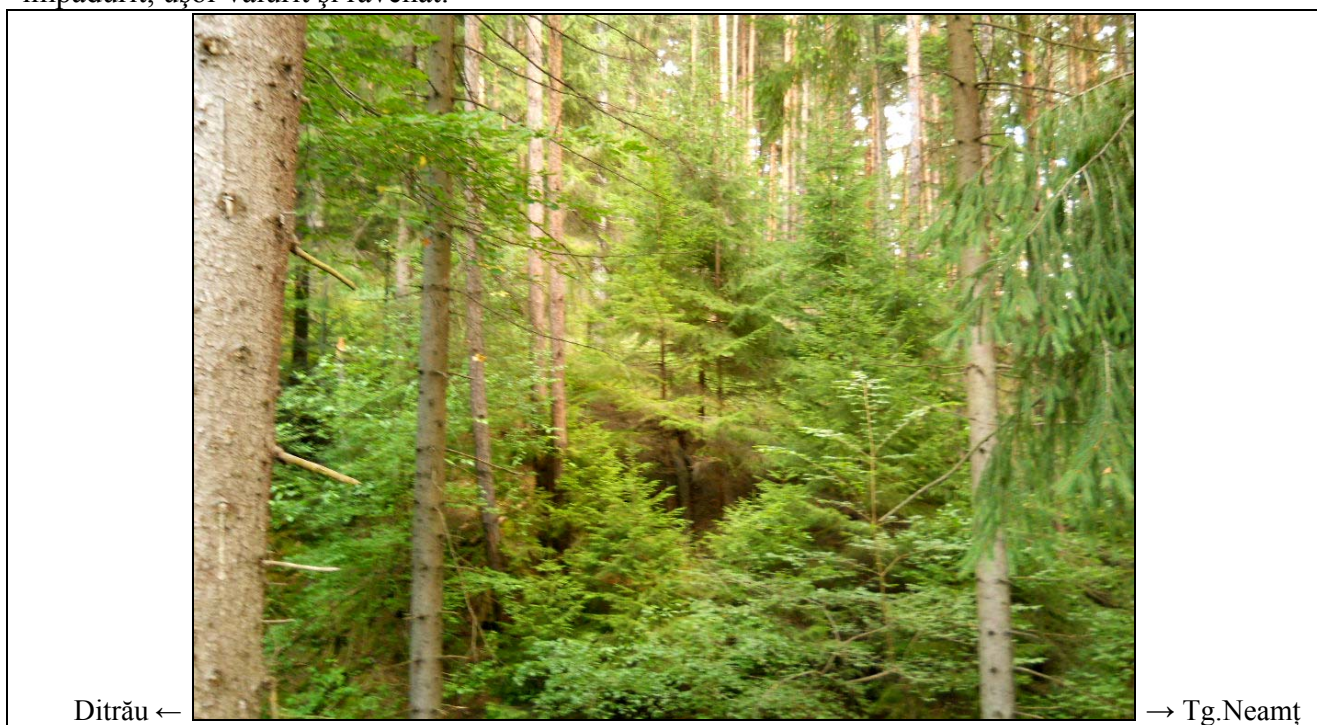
Detaliu traversare traseu proiectat peste ravina din zona km 55+530; detaliu foto din zona DN 15 (km 242+700 - kilometraj DN 15), la aproximativ 20 m stânga de locație foto.
